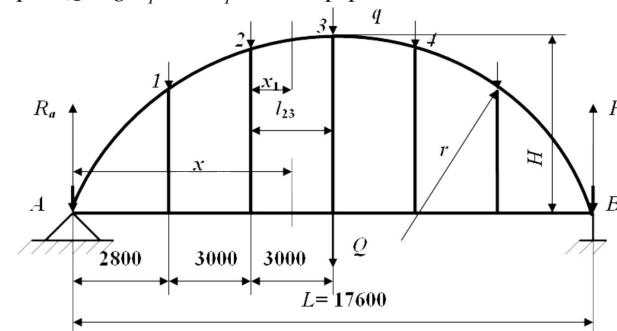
Розрахункова схема навантаження залізобетонної кроквяної аркової ферми
